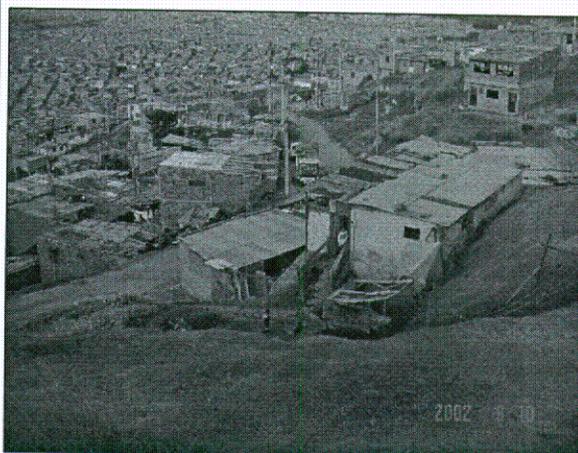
Panorámica de las viviendas 18 a 21 y 28.
